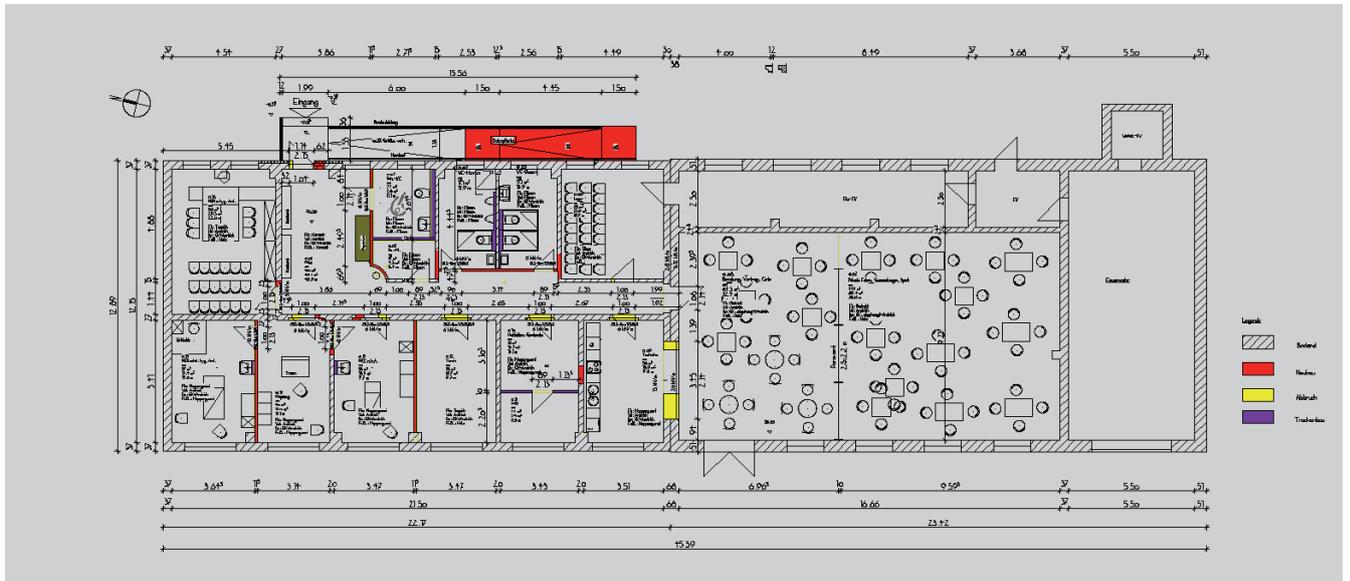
Grundriss Dorfgemeinschaftshaus Vogelsang-Warsin „Alte Schule m.H.“
